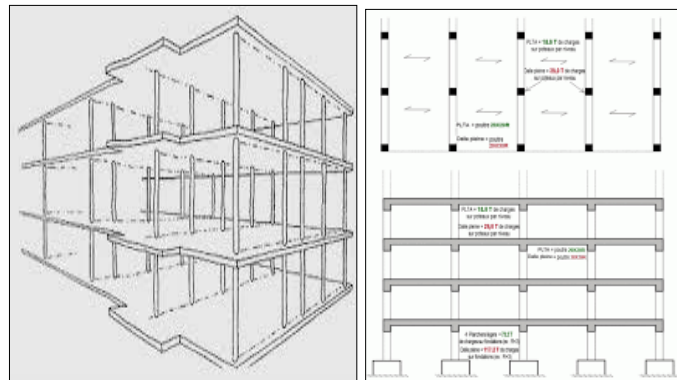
plan + coupe d'un system de structure pourtique SOURCE : <http://docs.autodesk.com>
